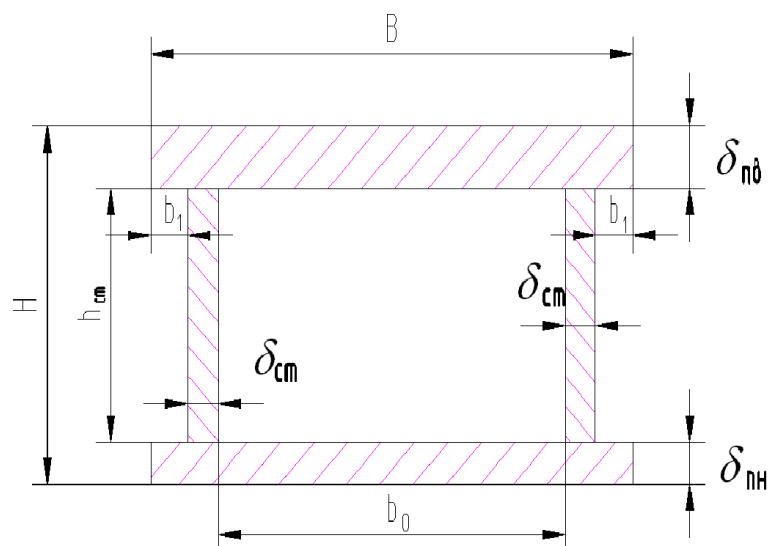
Поперечное сечение балки с рельсом между стенками.
